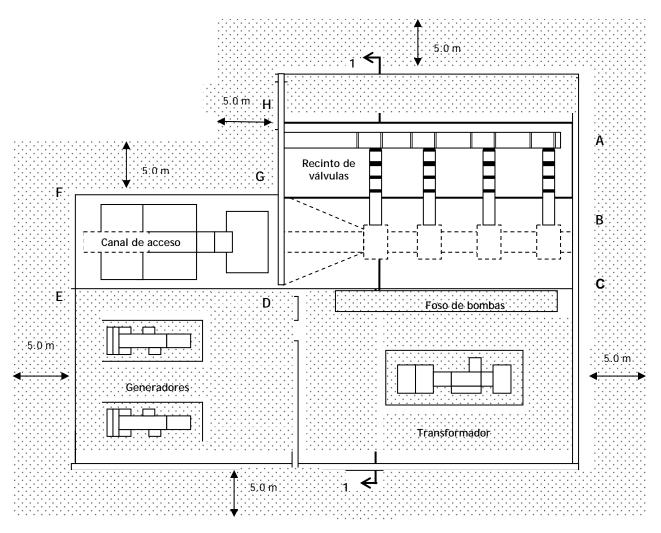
Detalle de las Zonas que deben Rellenarse - E.B. Matías Hernández - Planta
